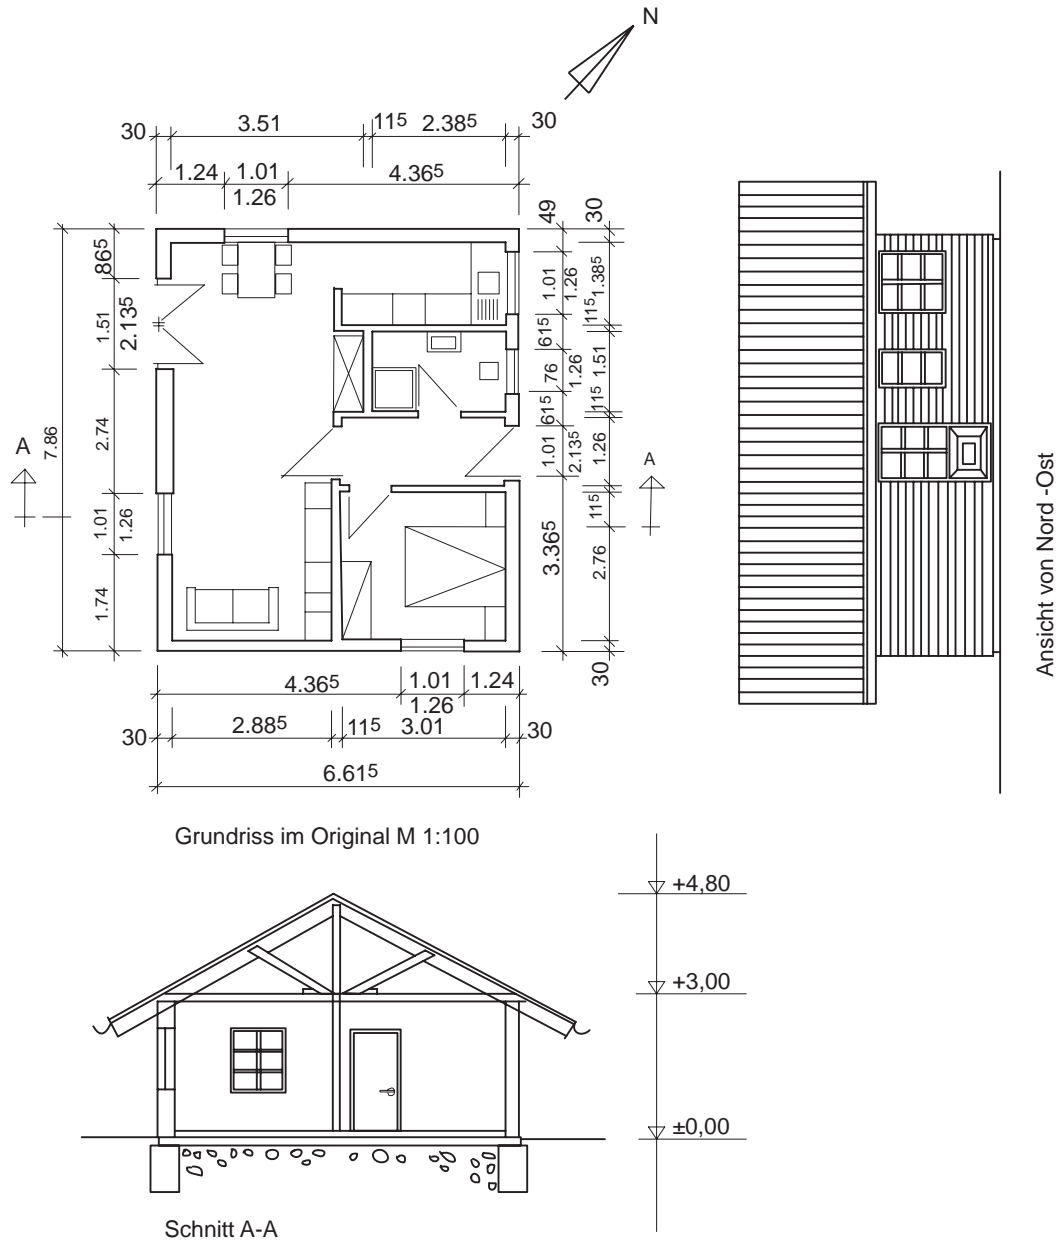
Ausführungsplan mit Baunennenmaßen (Auszug)
